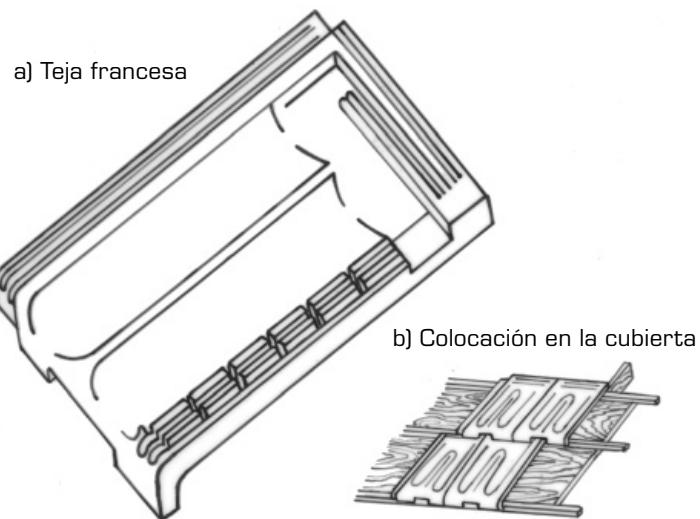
Tejas francesas para la colocación en la cubierta.
